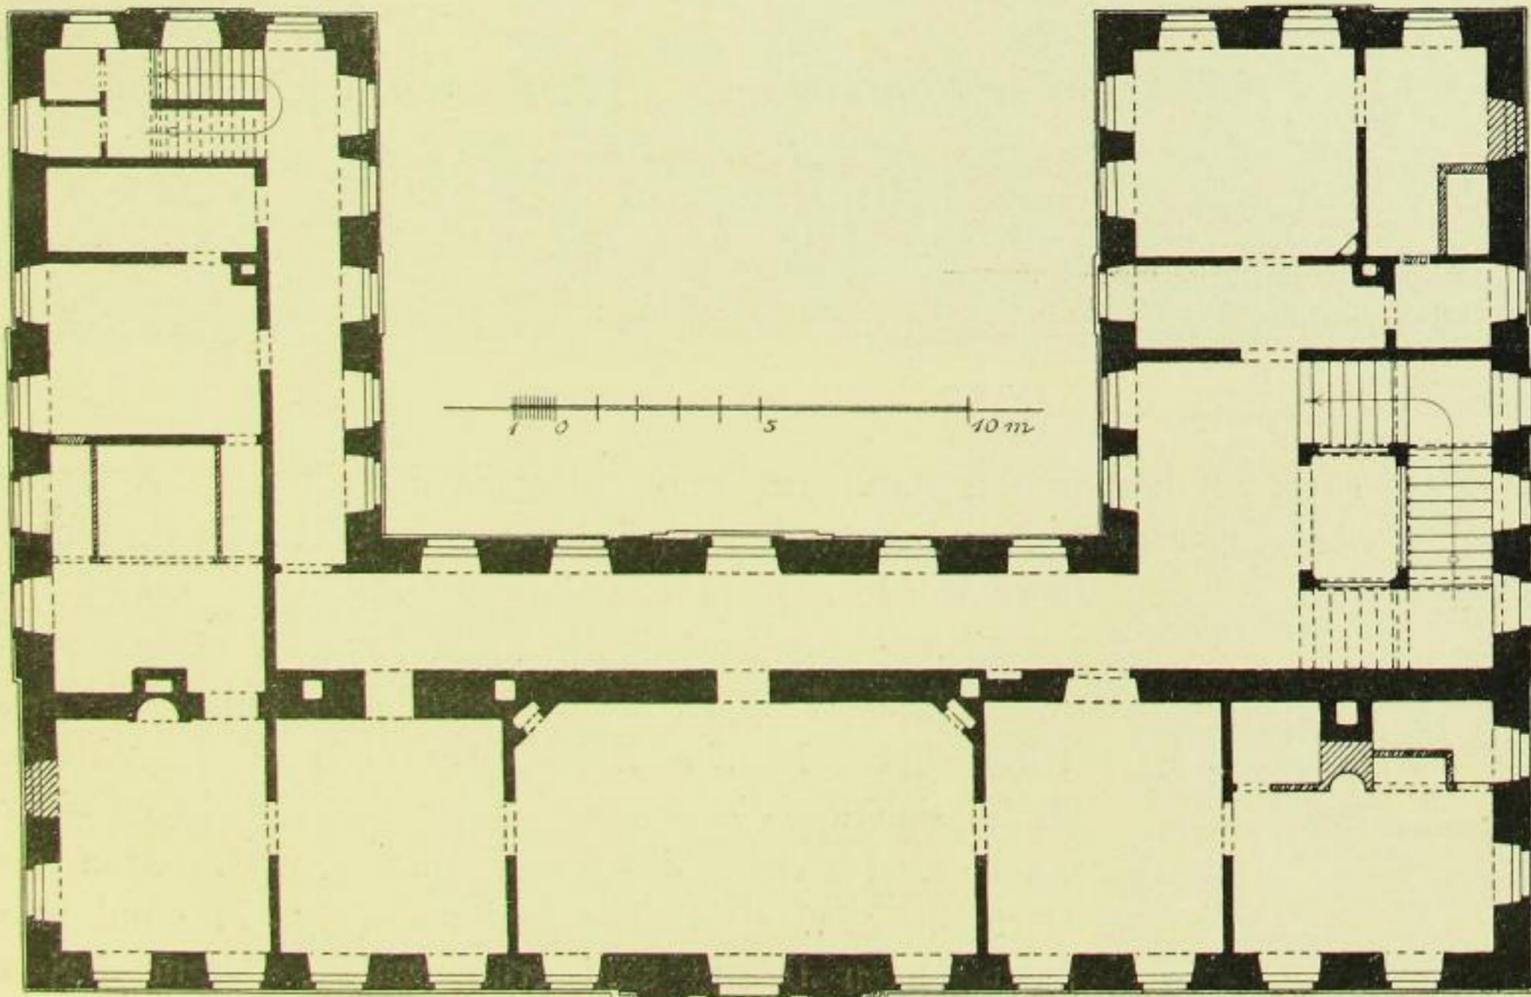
Canitz, Schloß, Grundriß des Obergeschosses.
